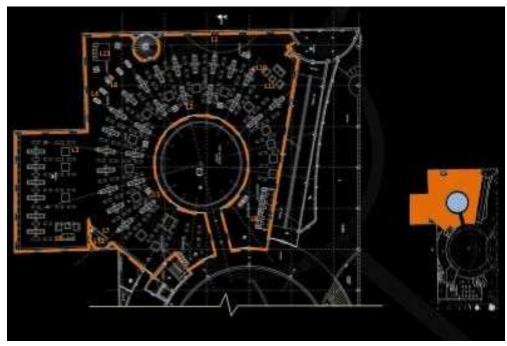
Plano de ubicación de los componentes en la planta de la librería Fuente: CAD
